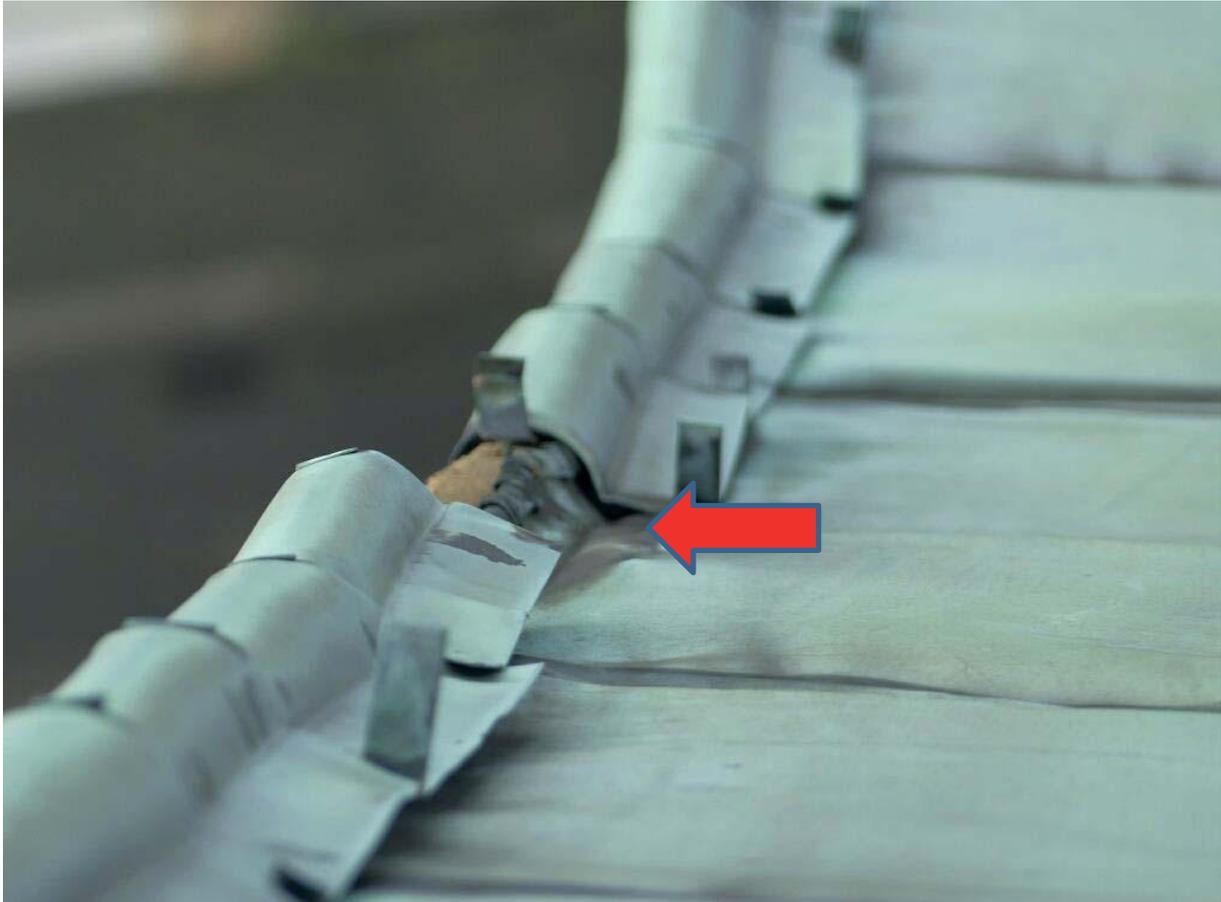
Lose Ortgangbleche. Verbund untereinander und mit der Dachhaut ist nicht mehr gegeben.
